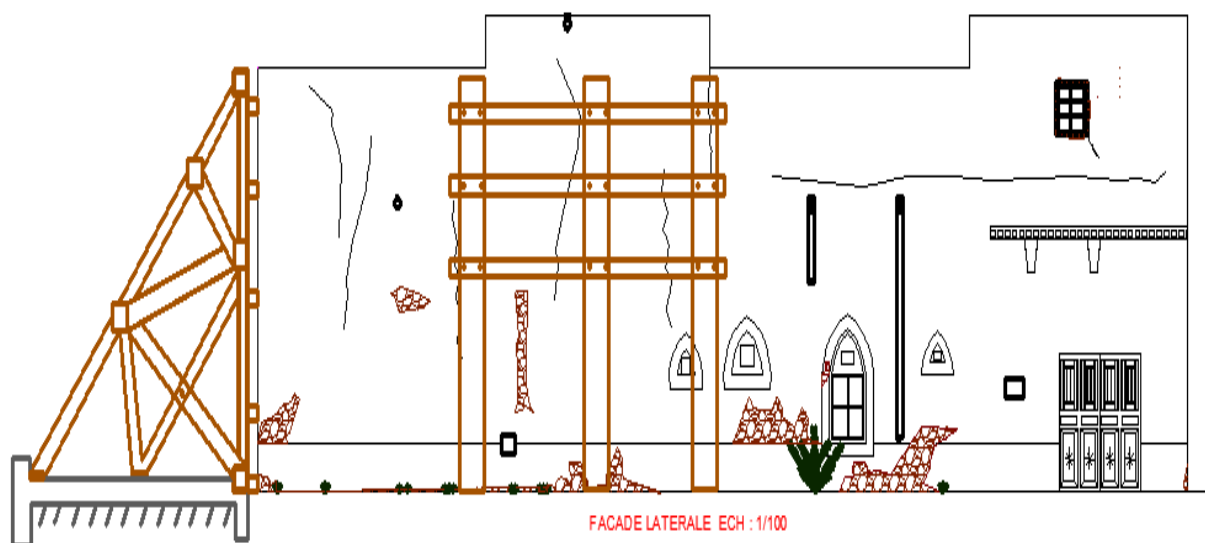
Consolidation des murs par des structures de type chevalet.
